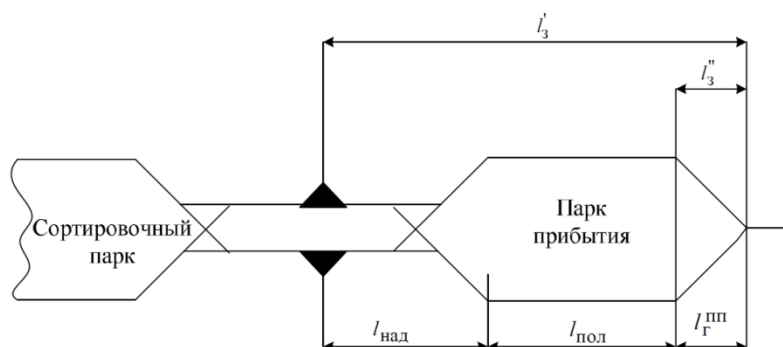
Схема расположения парка приема и сортировочного парка
